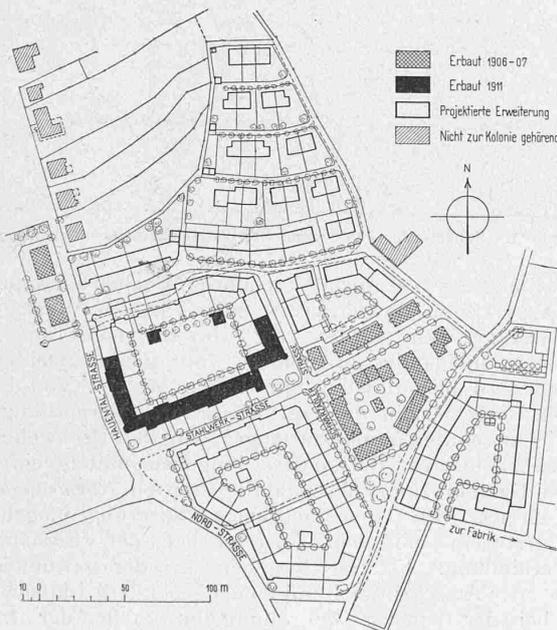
Lageplan der Gesamtanlage. — 1 : 4000.
